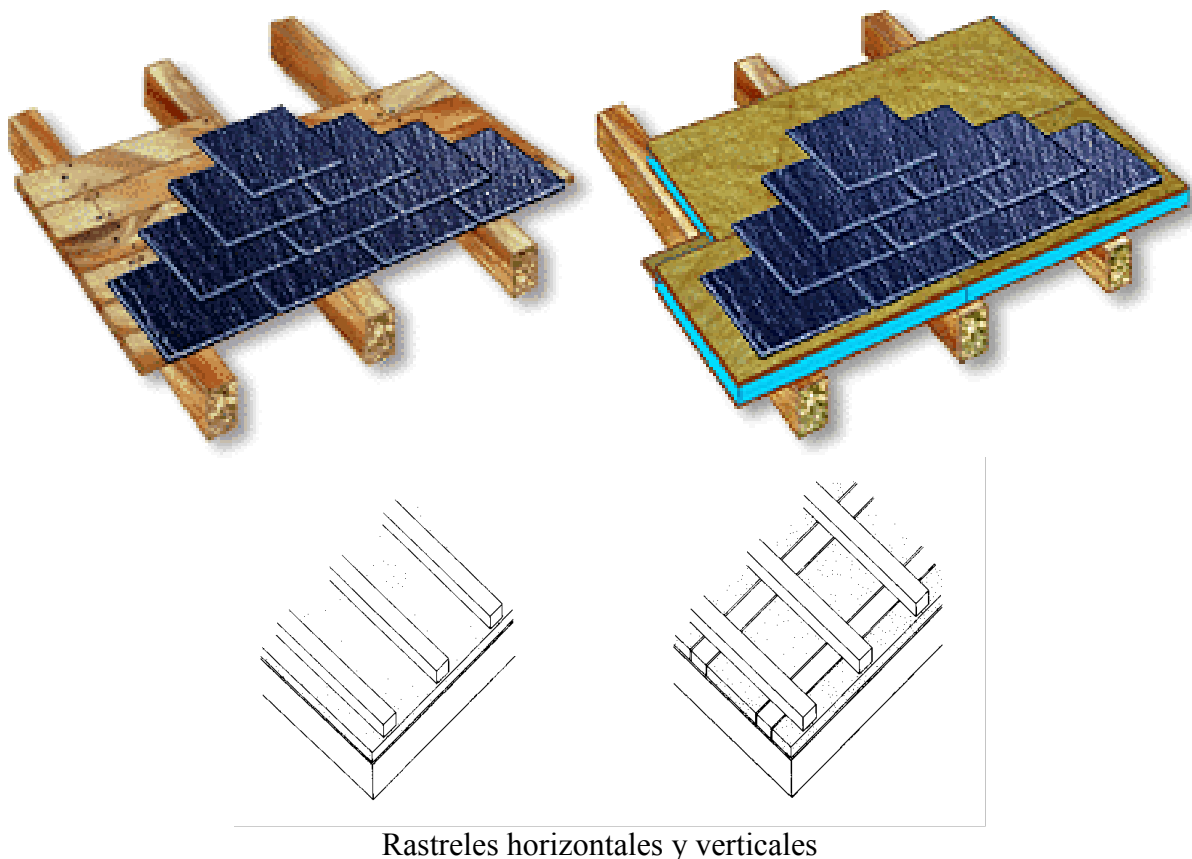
Estructura de la cubierta de madera.
